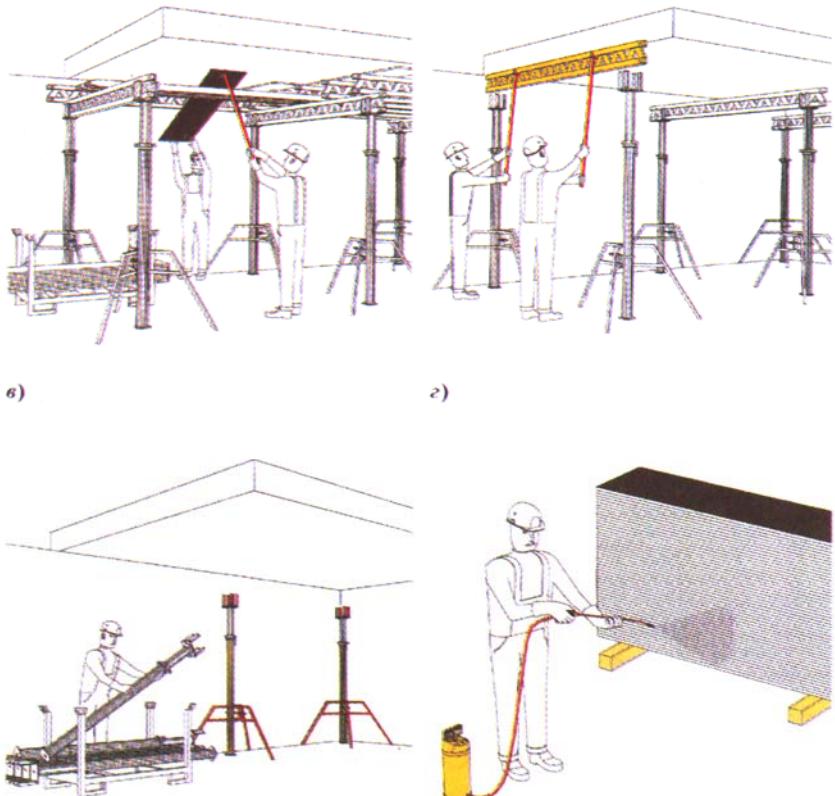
Демонтаж щитов опалубки и продольных балок
